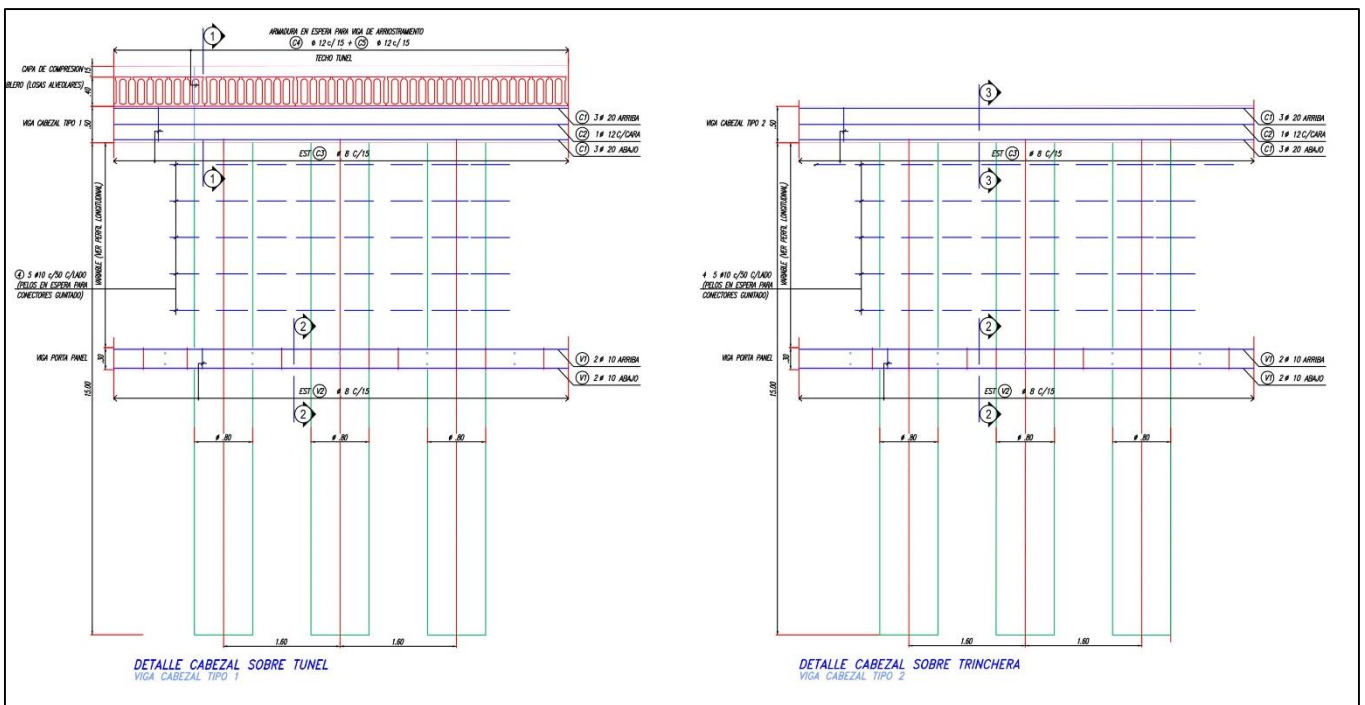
Perfil longitudinal de la viga dintel longitudinal en zona de túnel y en zona de trinchera (PLANO N° 27).
